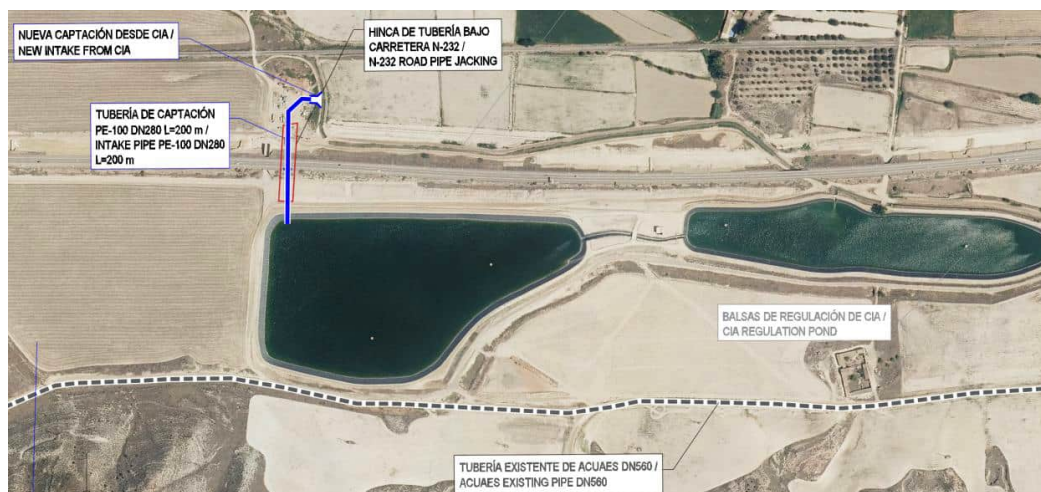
Conexión con tubería CIA. Fuente: AECOM.
